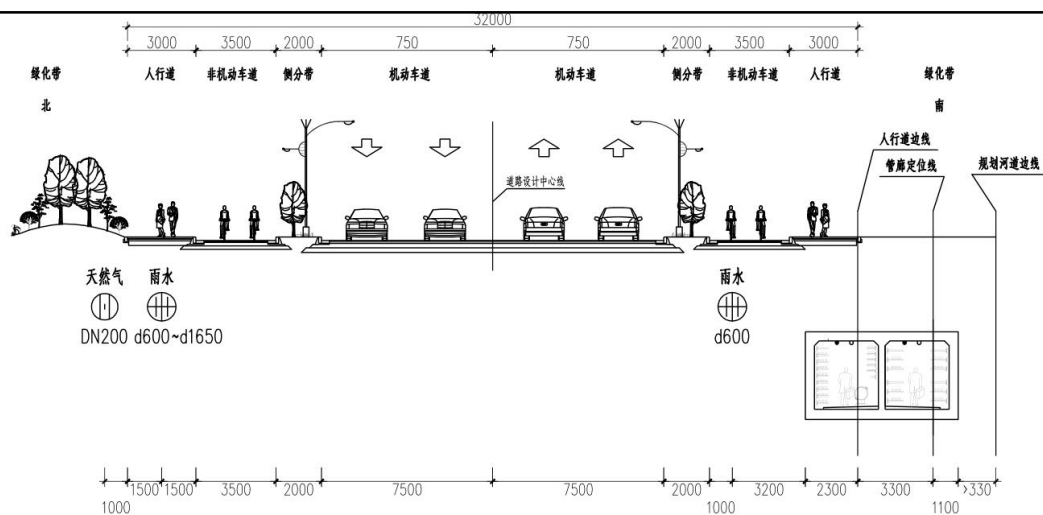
管线标准横断面布置示意图 (K1+360~学融街段)
